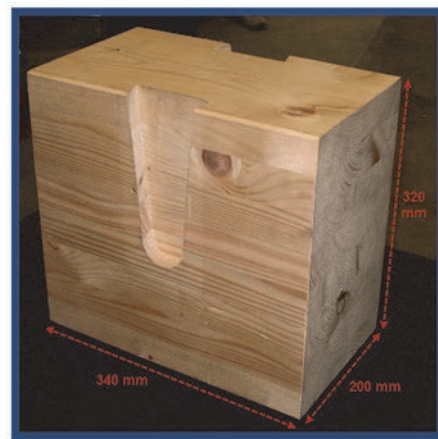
Probeta de madera laminada de píce de sección de viga con mortajas talladas que reciben a las viguetas
